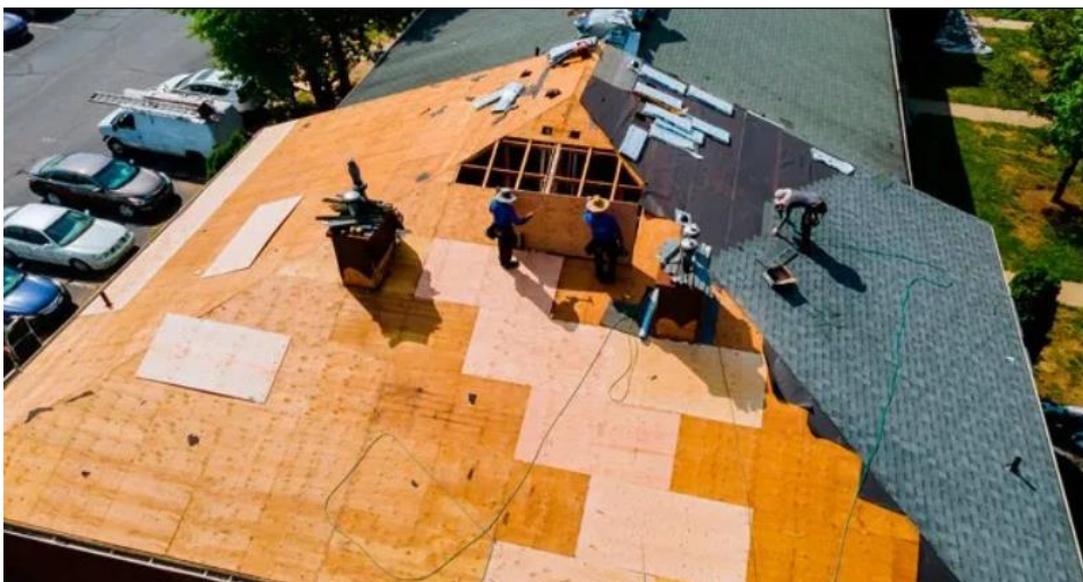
Execução de telhado do tipo Shingle. Fonte: Portal AECweb, 2021.
